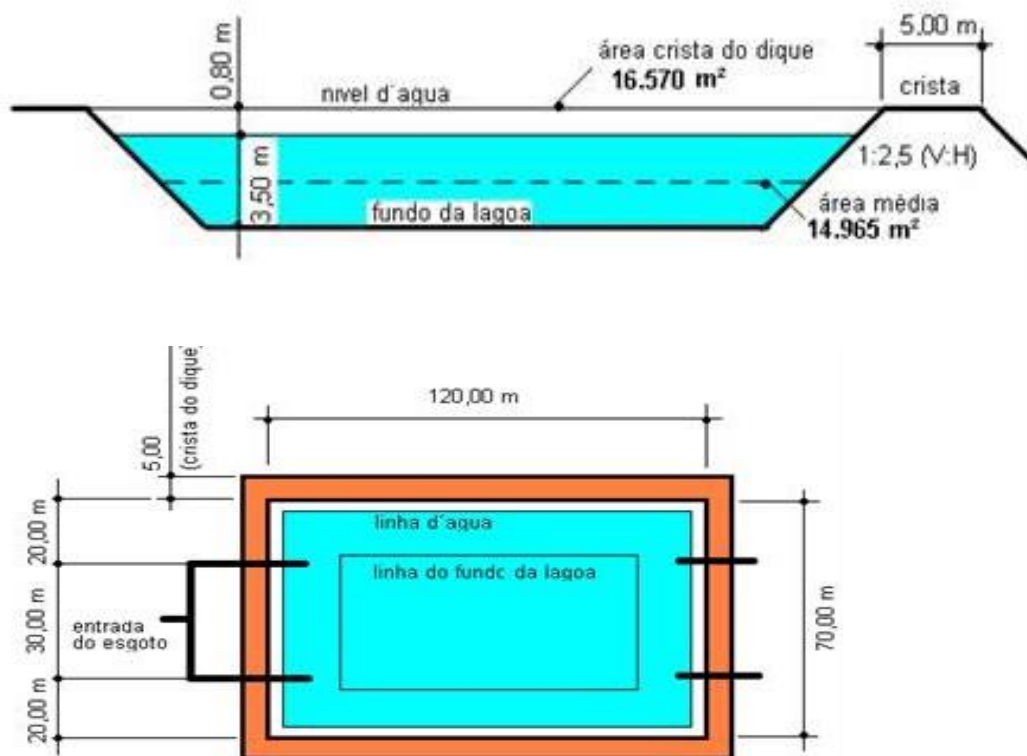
6: LAGOA ANAERÓBIA – SEÇÃO VERTICAL E PLANTA (SEM ESCALA)
